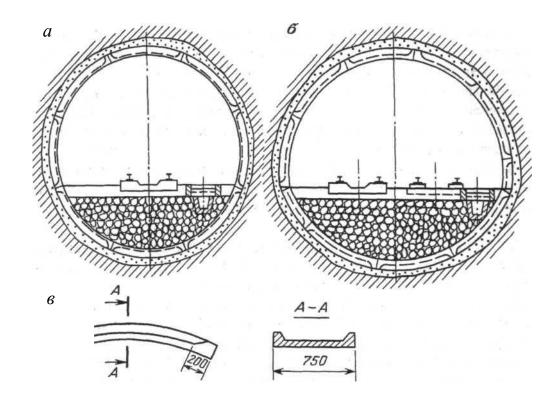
Конструкции железобетонных гладкостенных тюбинговых крепей Куз-НИИшахтостроя
